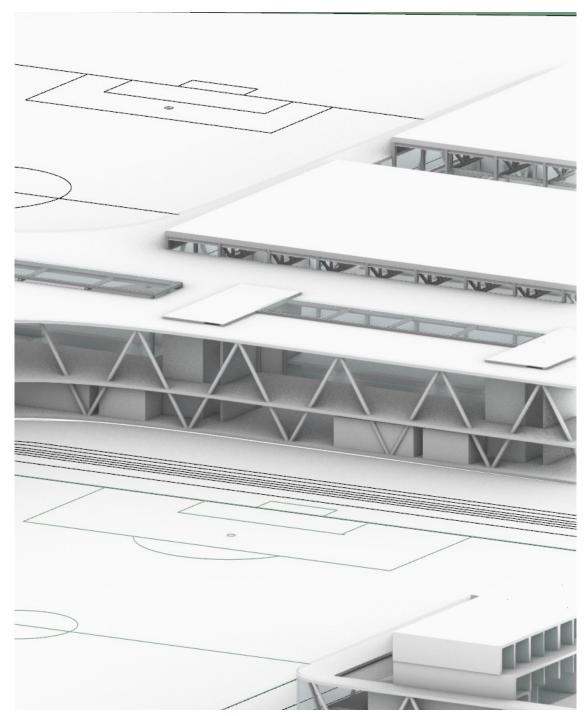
Konstruktionsvariante-Fachwerk-Stahl
